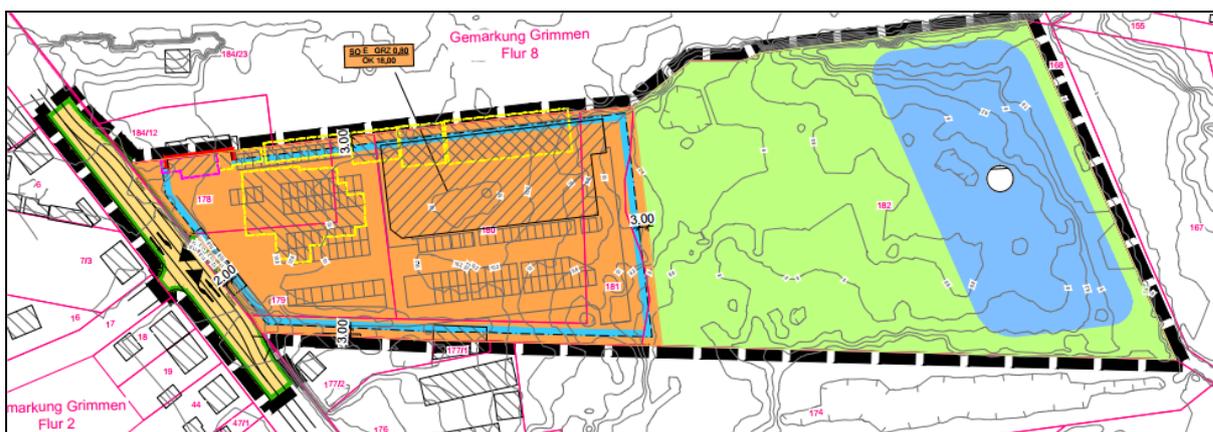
Lageplan mit Darstellung der zukünftigen Bebauung
